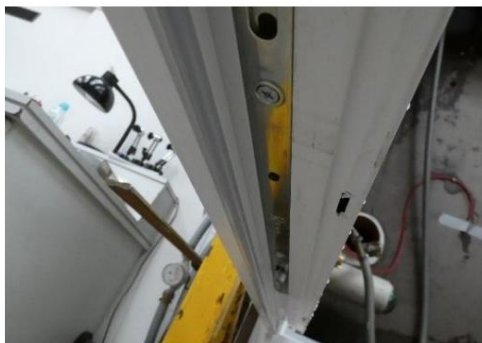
Sigillatura angolo inferiore telaio destro; visibile riscontro ad inclinazione verticale e feritoia di ingresso drenaggio
